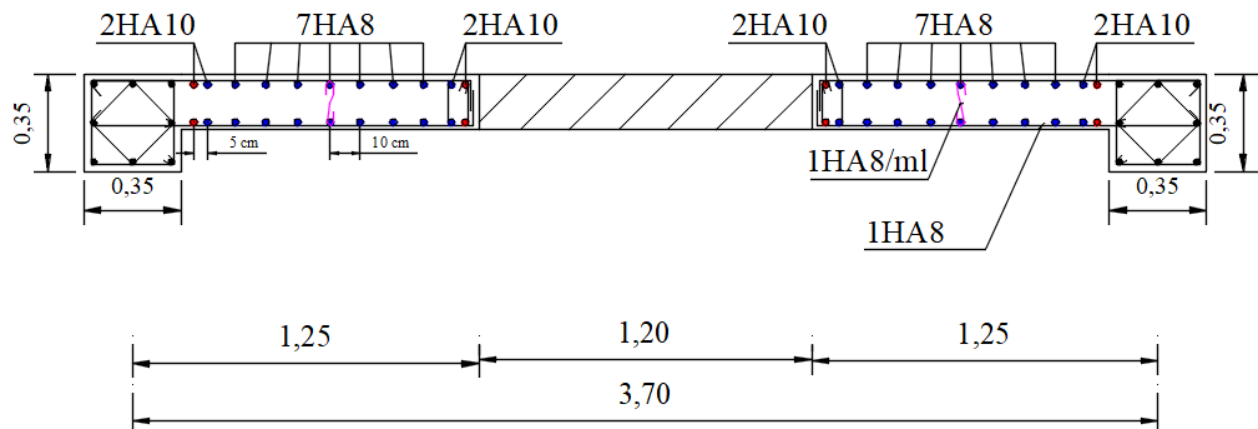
Schéma de ferrailage du trumeau VL4.
